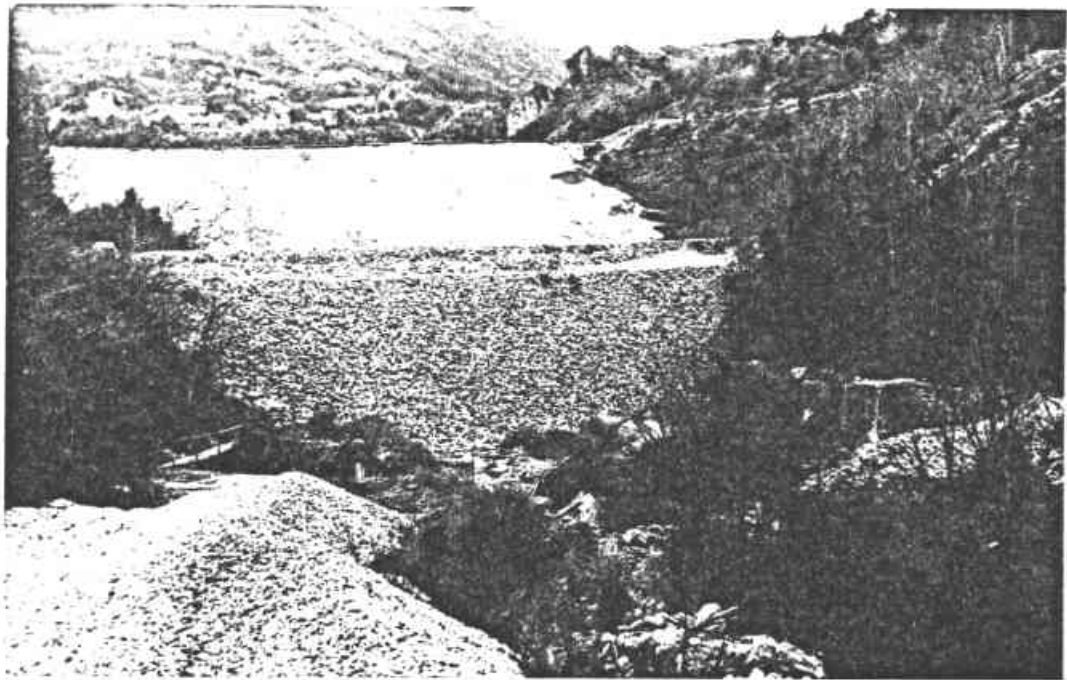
Talus aval de la digue avec au premier plan, le mur d'arrêt définitif en enrochement (galets et graviers de rivière). A droite, l'exutoire du tunnel de la Crenze.
